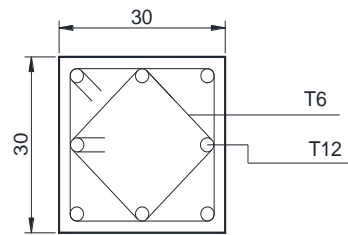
Ferrailage d'un poteau 30x30cm (poutres normales - bâtiment R+3)
